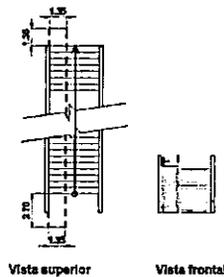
Sinalização de piso junto à plataforma de elevação inclinada
